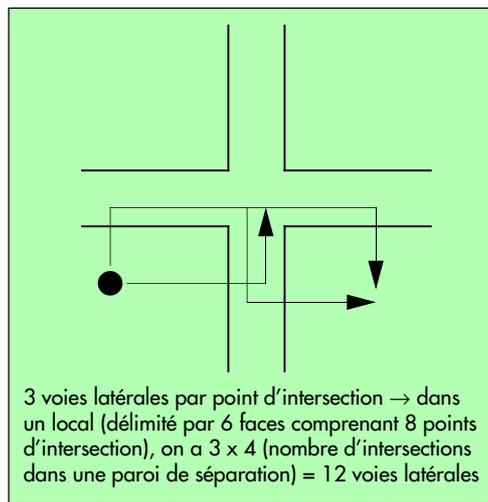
Voies de transmission latérales au croisement de deux murs ou d'un mur et d'une dalle (coupe verticale ou horizontale).
